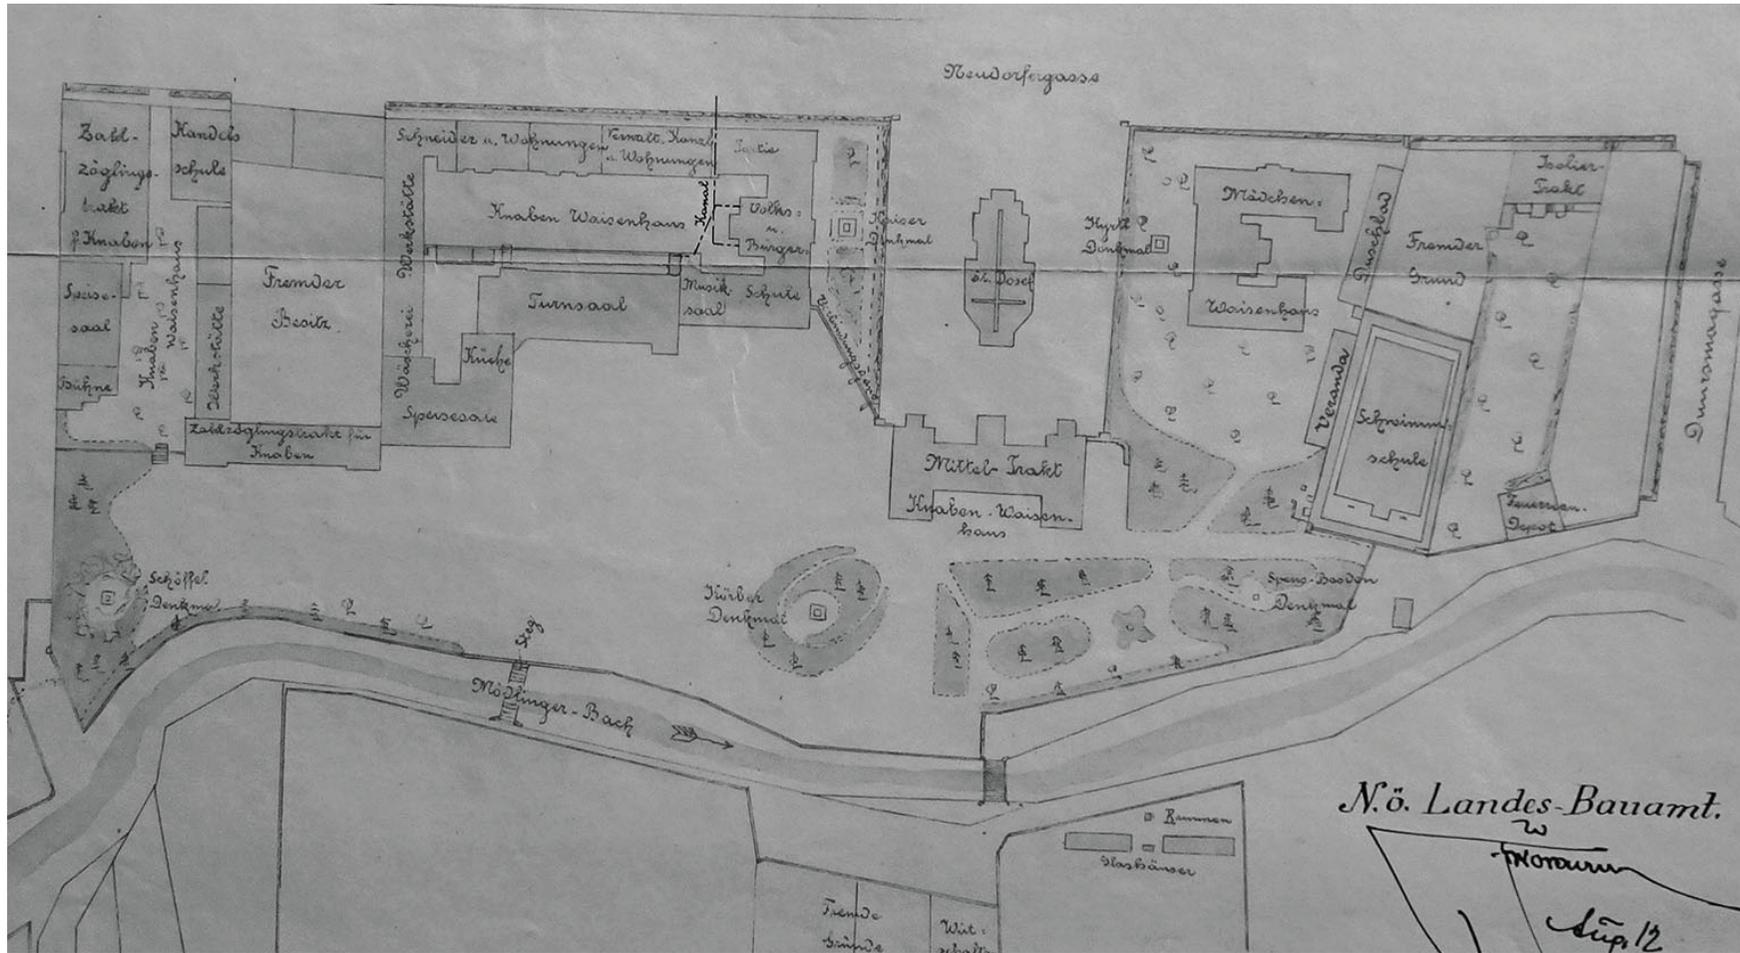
Lageplan des Waisenhausareals, ca. 1910
